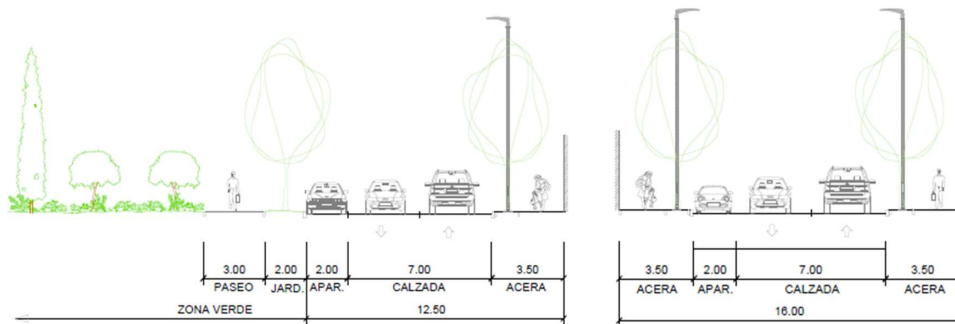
Secciones tipo de viario de 12,50 y 16m.
